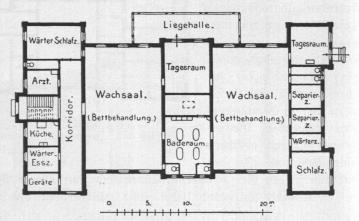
Irrenanstalt Langenhorn, Krankengebäude für Kranke und Gelähmte, Erdgeschoß, Grundriß.
